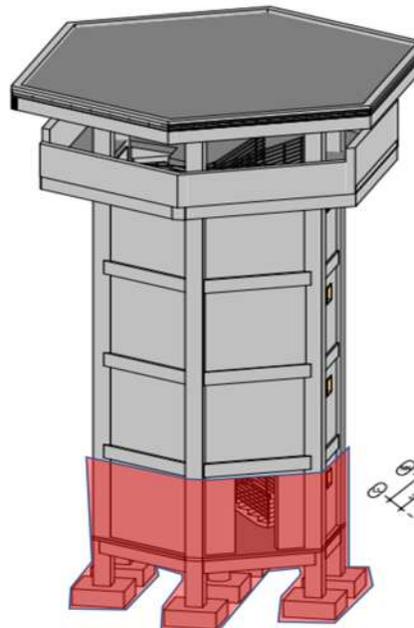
21/05/2025. Estado actual de avance: Resaltado en color rojo: Construido - Color gris: por construir.
